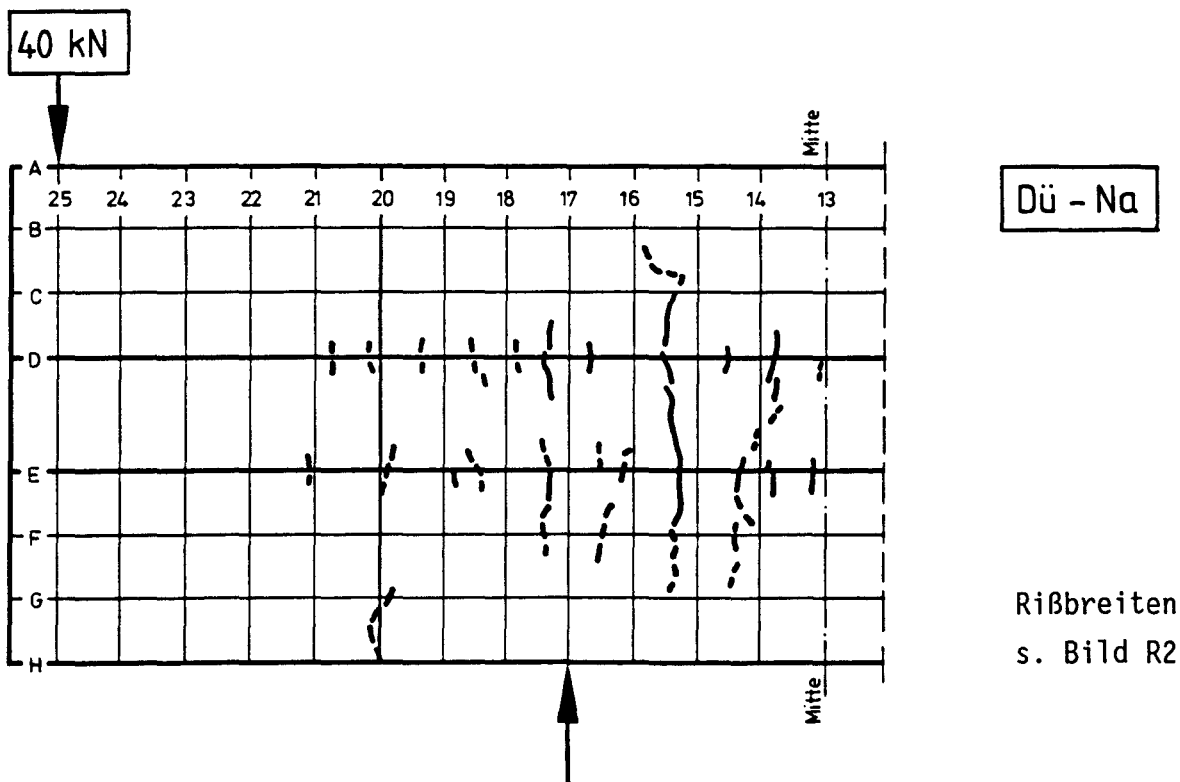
Rißbild unter Gebrauchslast, Ergänzung mit Normalbeton
